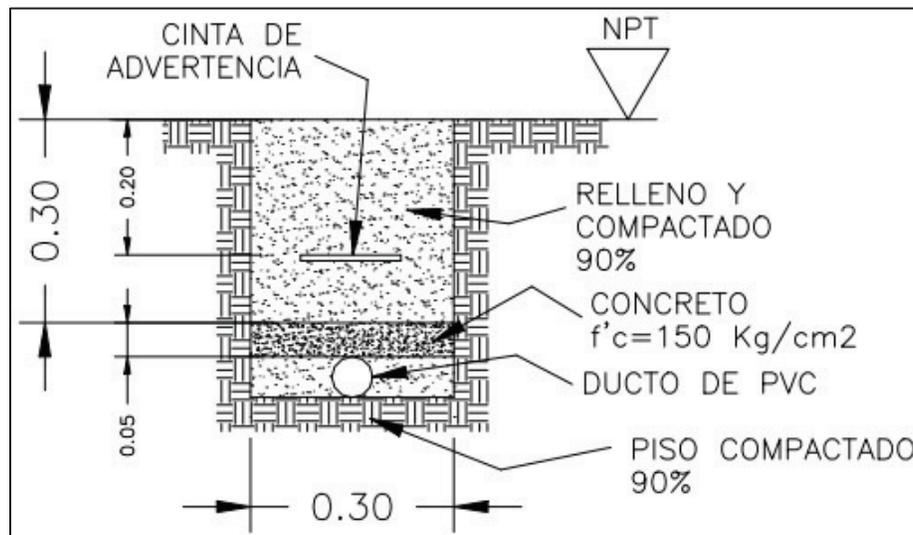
Detalle Ceba en Baqueta con Ducto de PVC.
